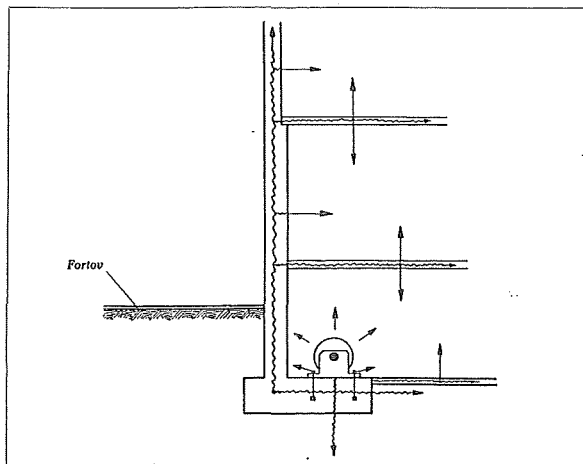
Maskinstøj fra Motor i Kælderetage.
